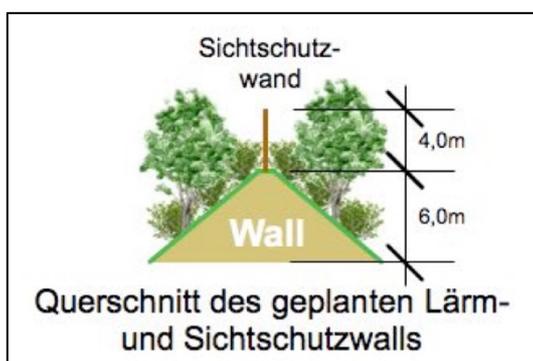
Lärm-/Sichtschutzwall mit -wand
